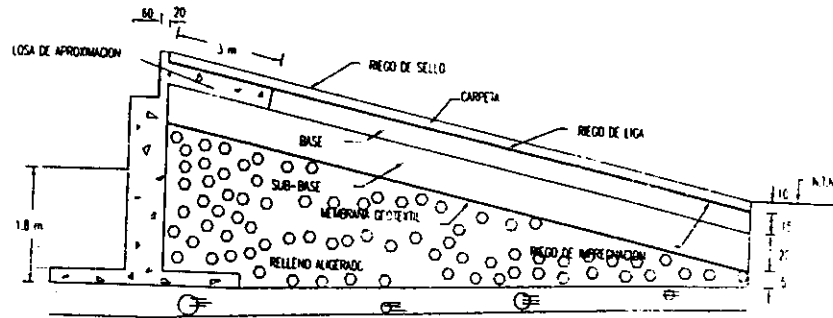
ESTRIBO Y RAMPA DE CONEXIÓN
